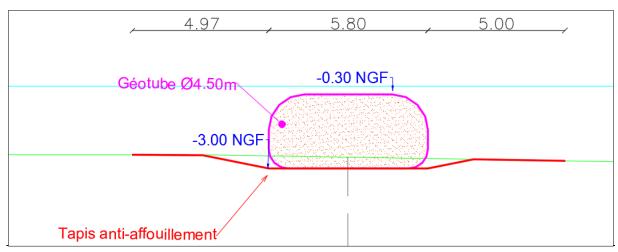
Coupe type selon B-B' du brise lame en géotextile sur la plage du Centre-Ville
